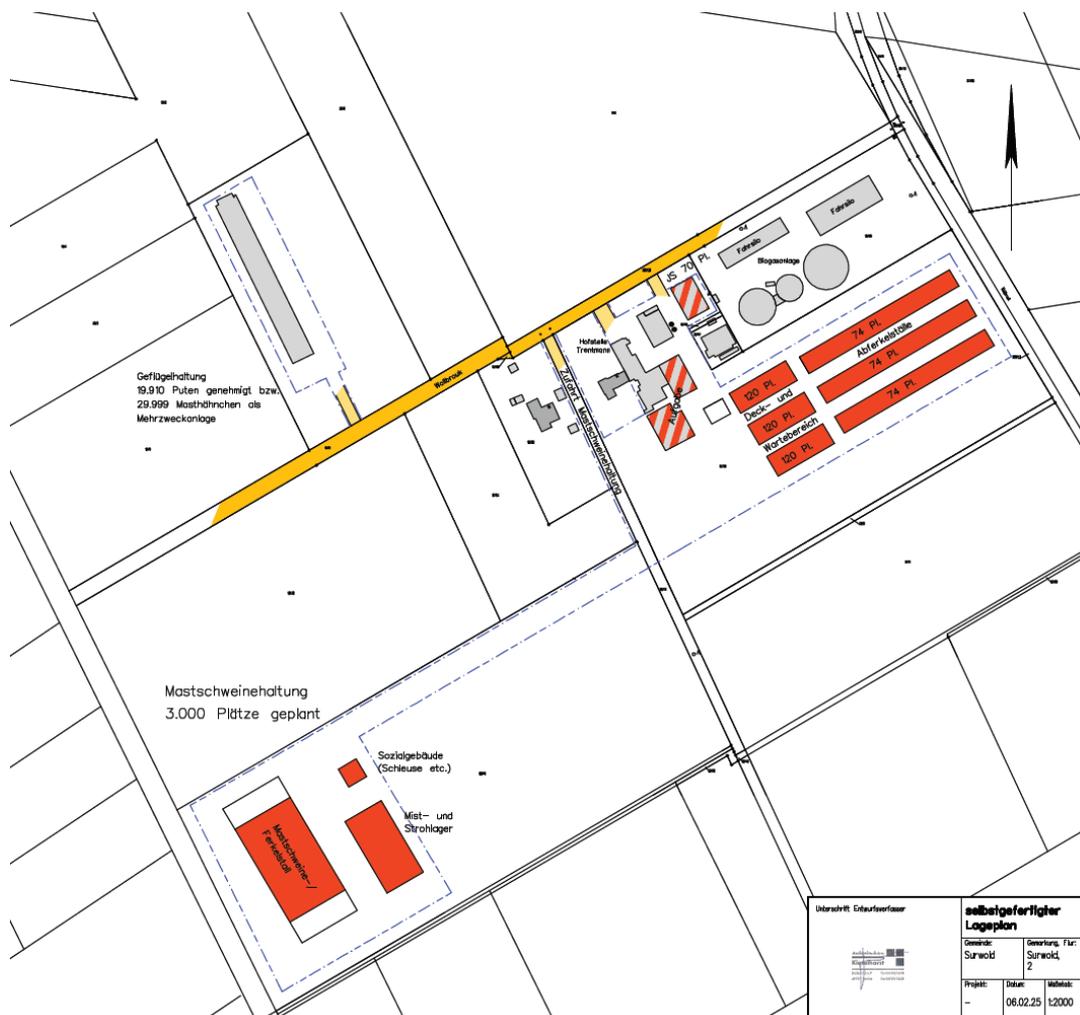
Lageplan zu den geplanten Bauvorhaben, unmaßstäblich (Kieselhorst 2024)
